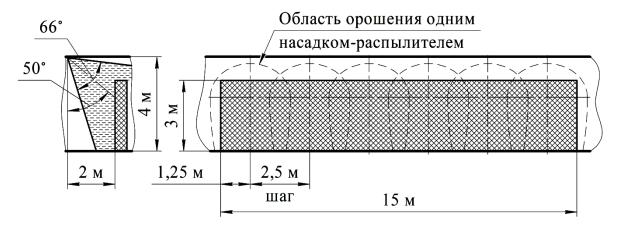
Противопожарная защита боковой поверхности стеллажа 6-ю насадками-распылителями
